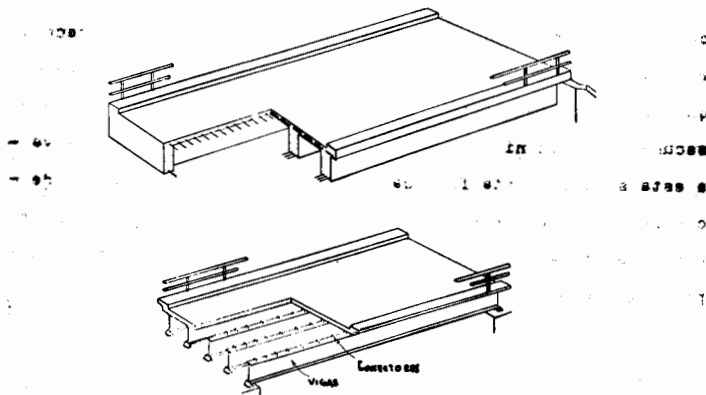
Puente con losa de concreto apoyada en travesas
